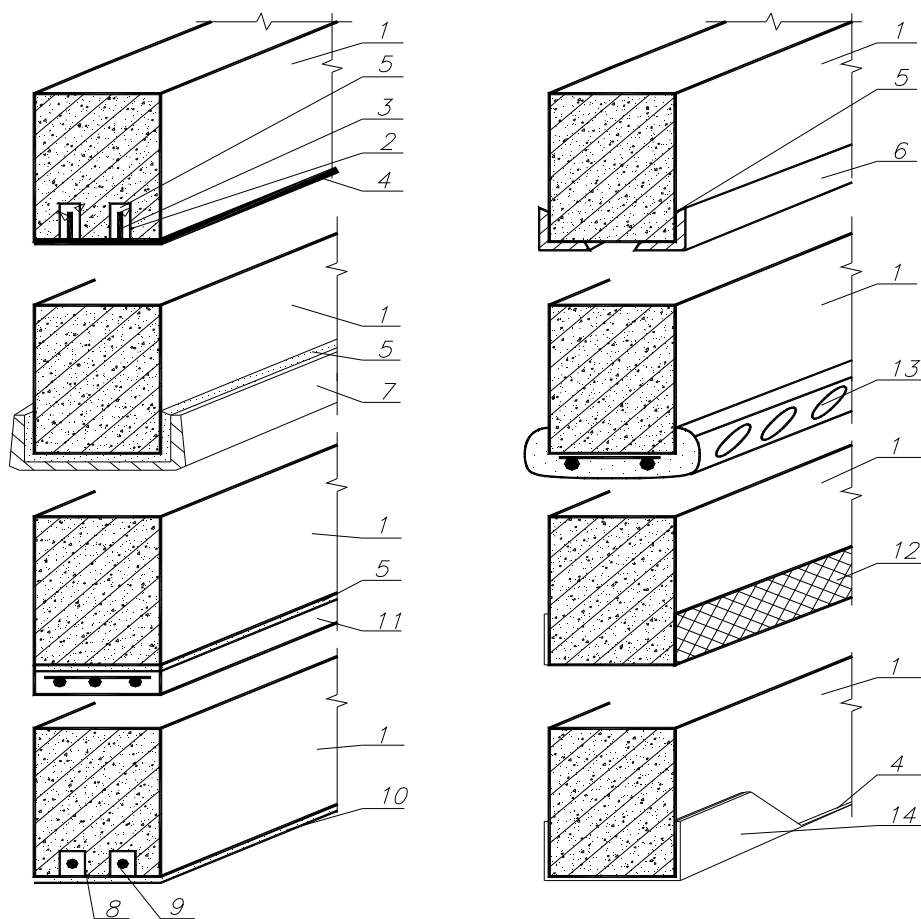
Усиление растянутой зоны конструкции приклеиванием дополнительной арматуры: 1 – усиливаемая конструкция; 2 – шурф; 3 – анкер; 4 – листовая арматура; 5 – полимерраствор; 6 – уголок; 7 – швеллер; 8 – паз; 9 – стержневая арматура; 10 – обмазка из полимерраствора; 11 – сборный железобетонный элемент; 12 – стеклоткань; 13 – тонкий лист с выштамповками; 14 – анкерная пластина
